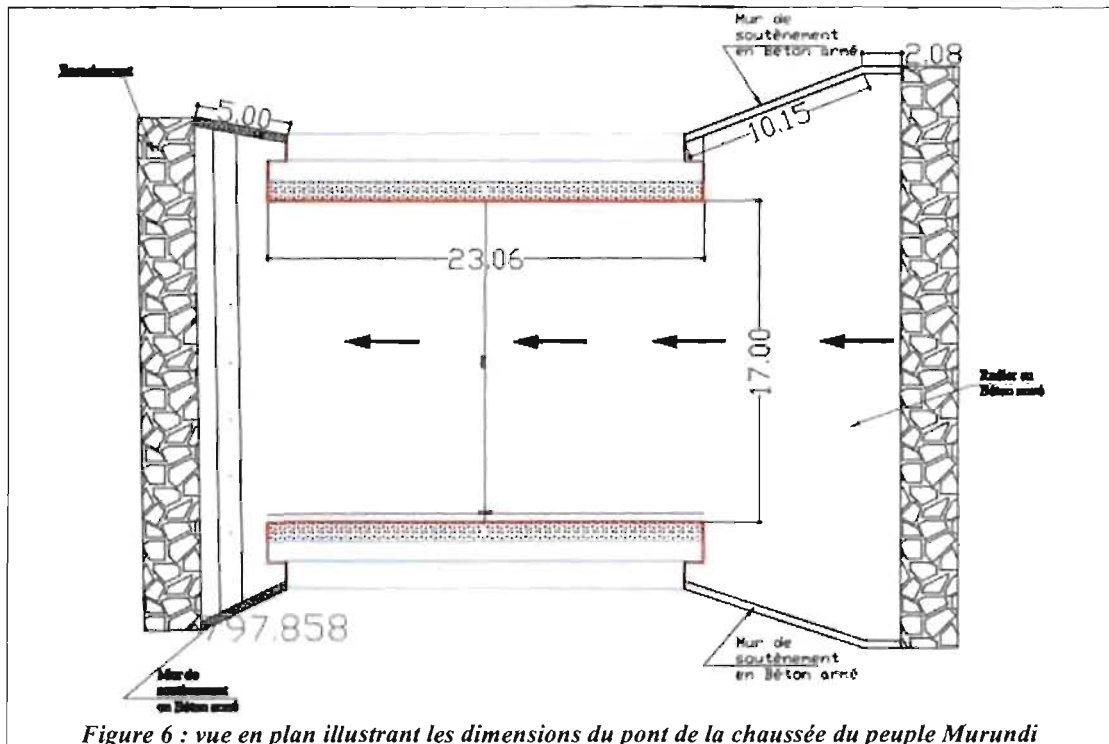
vue en plan illustrant les dimensions du pont de la chaussée du peuple Murundi
